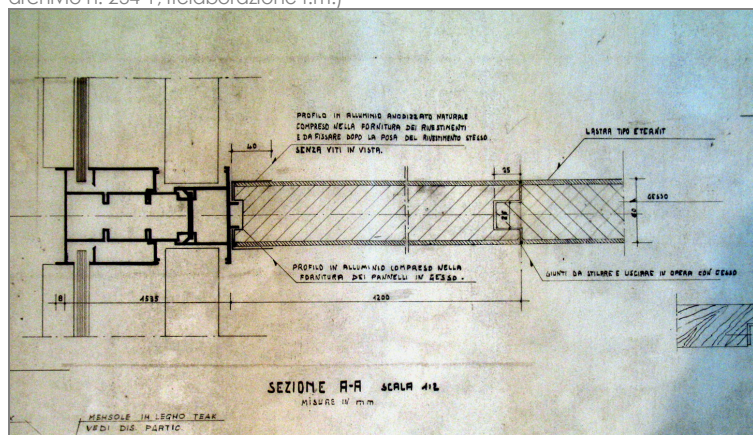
sezione AA (riferita a fig.20) - (fonte CSAC - stralcio tav. 60, archivio n. 234-1)
